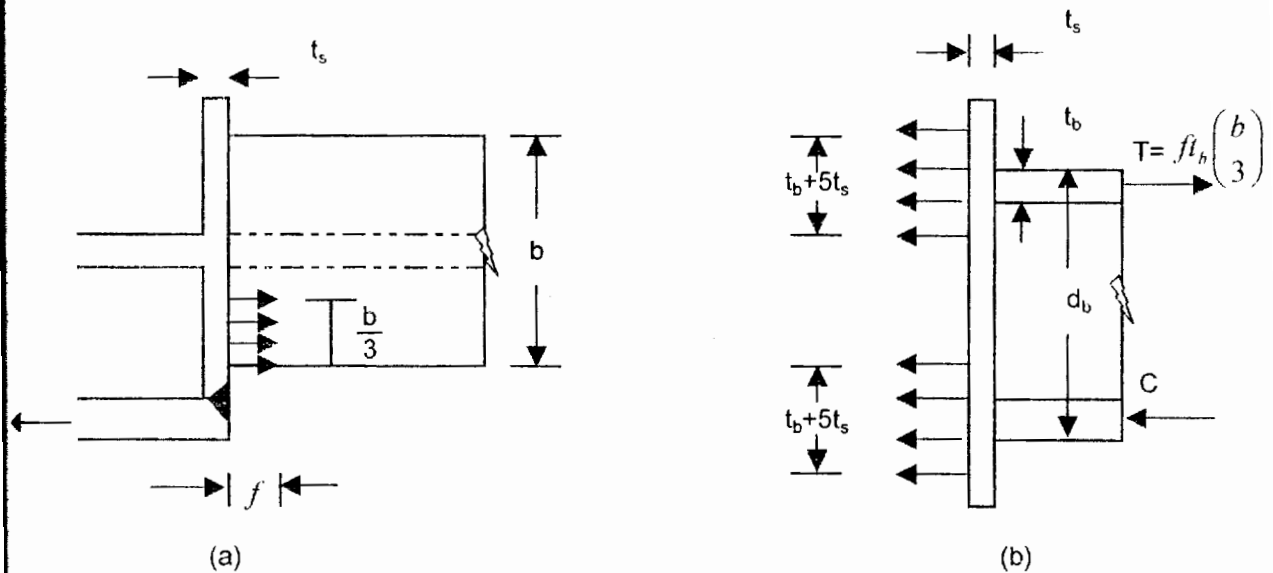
fuerzas llevado por la soldadura a lo largo de los patines de la T rigidizador.
